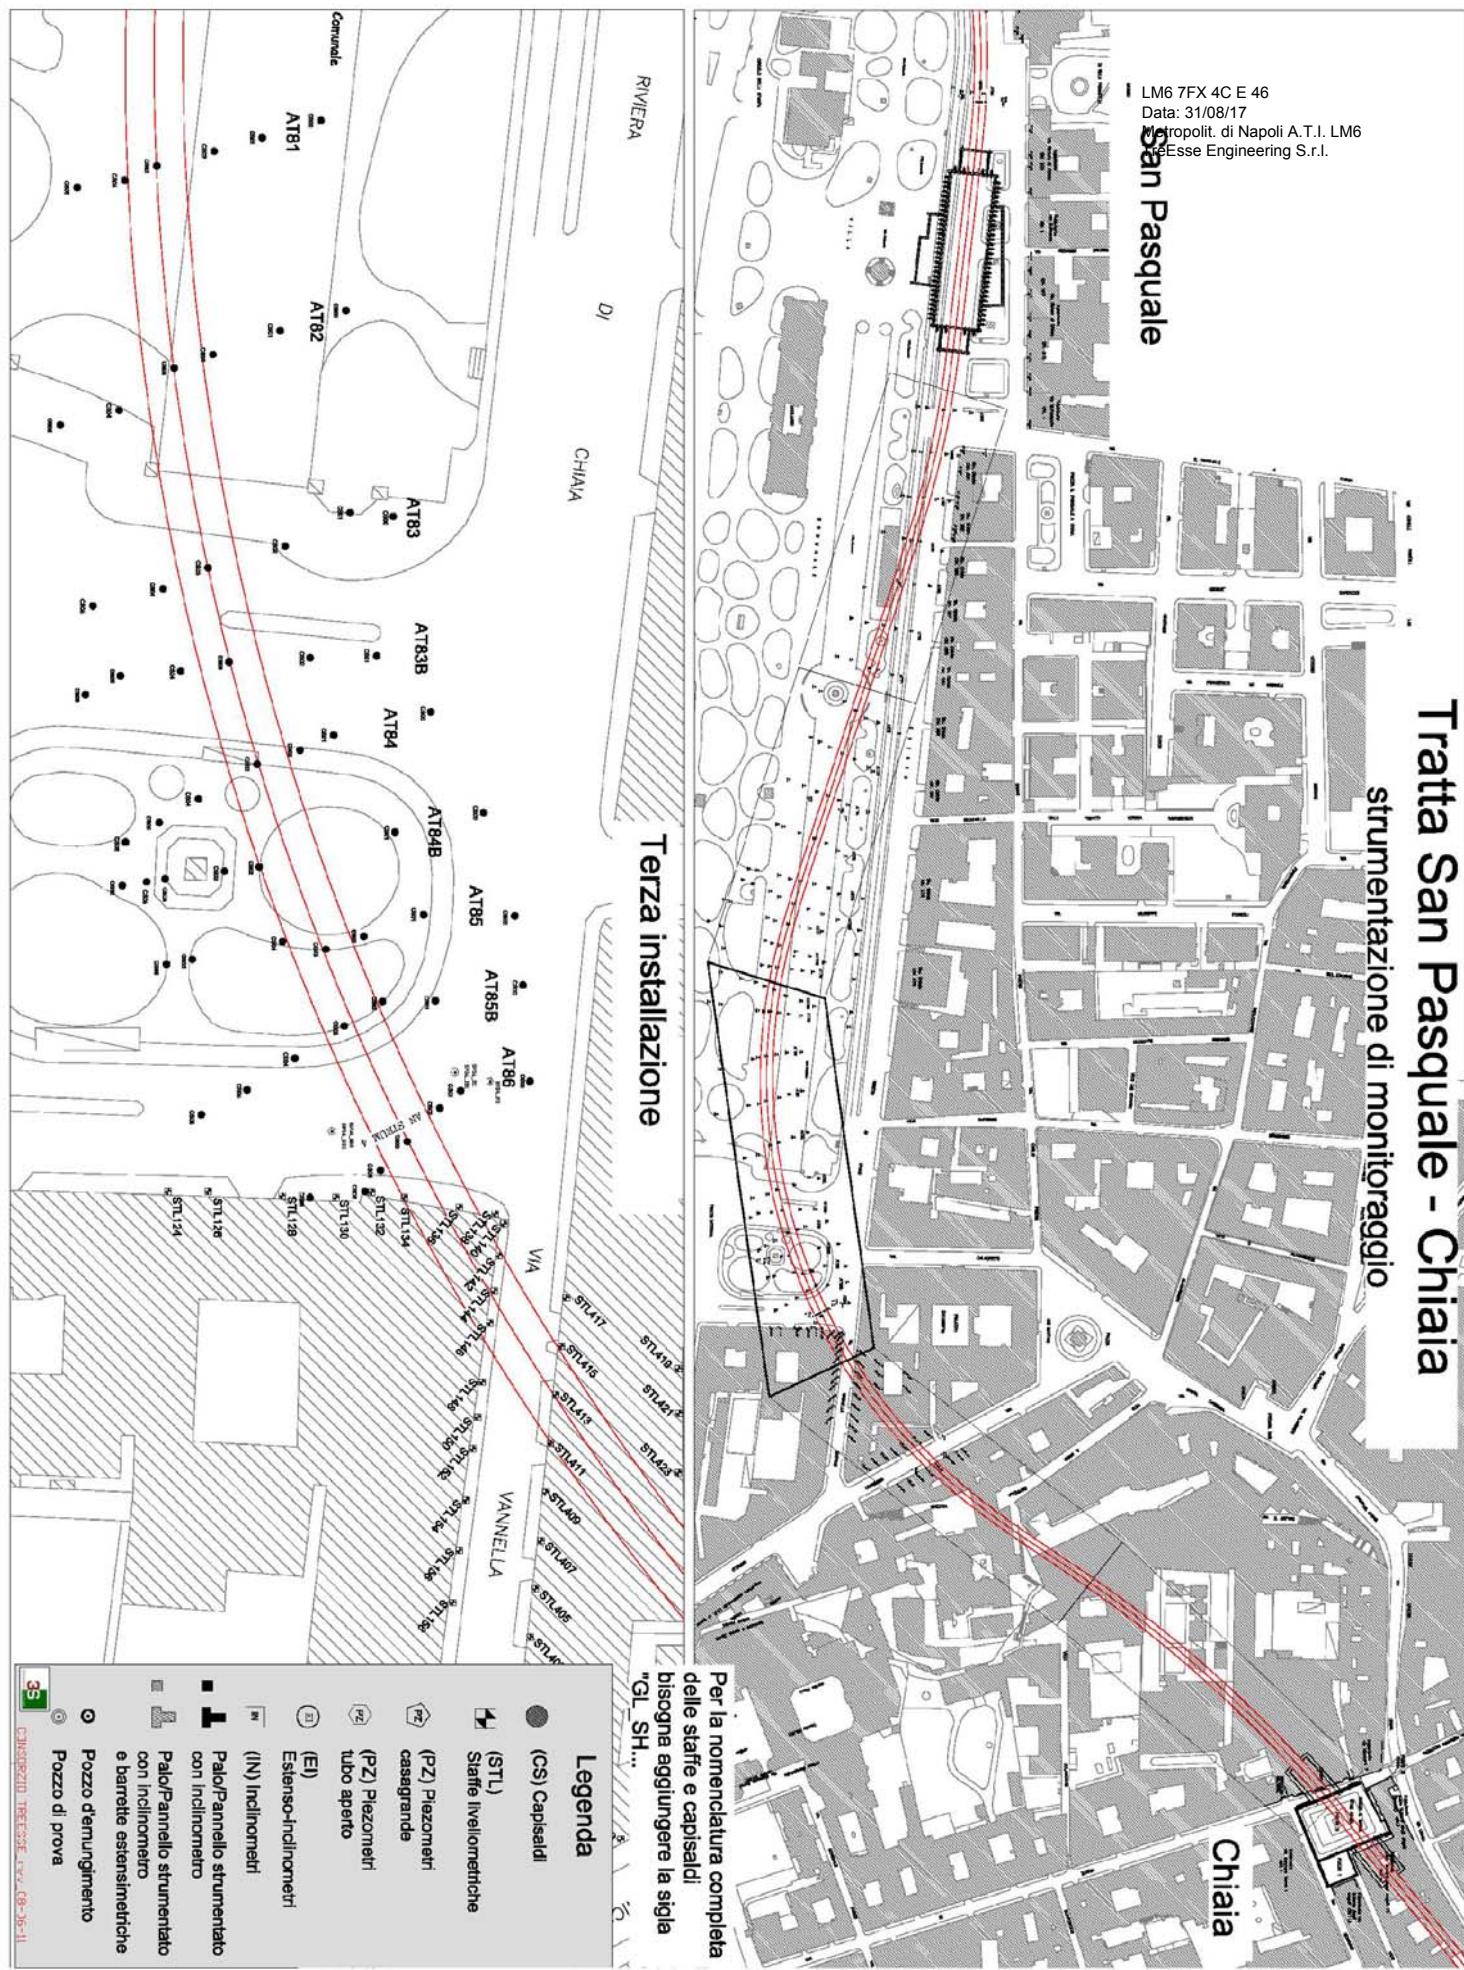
Planimetria tratta da San Pasquale - Chiaia, raffigurante la disposizione della terza installazione della strumentazione di monitoraggio.
